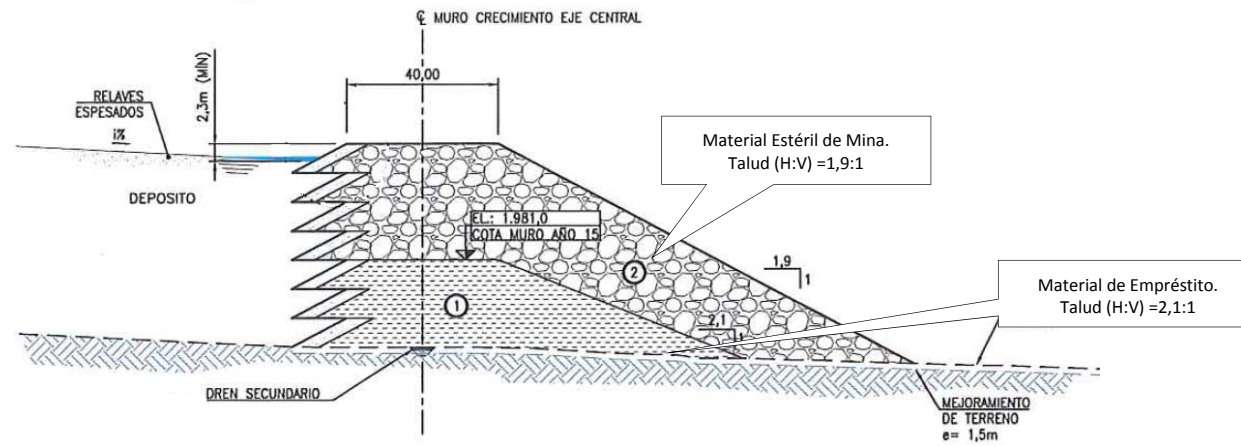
Sección Tipo, Muro Crecimiento Eje Central
